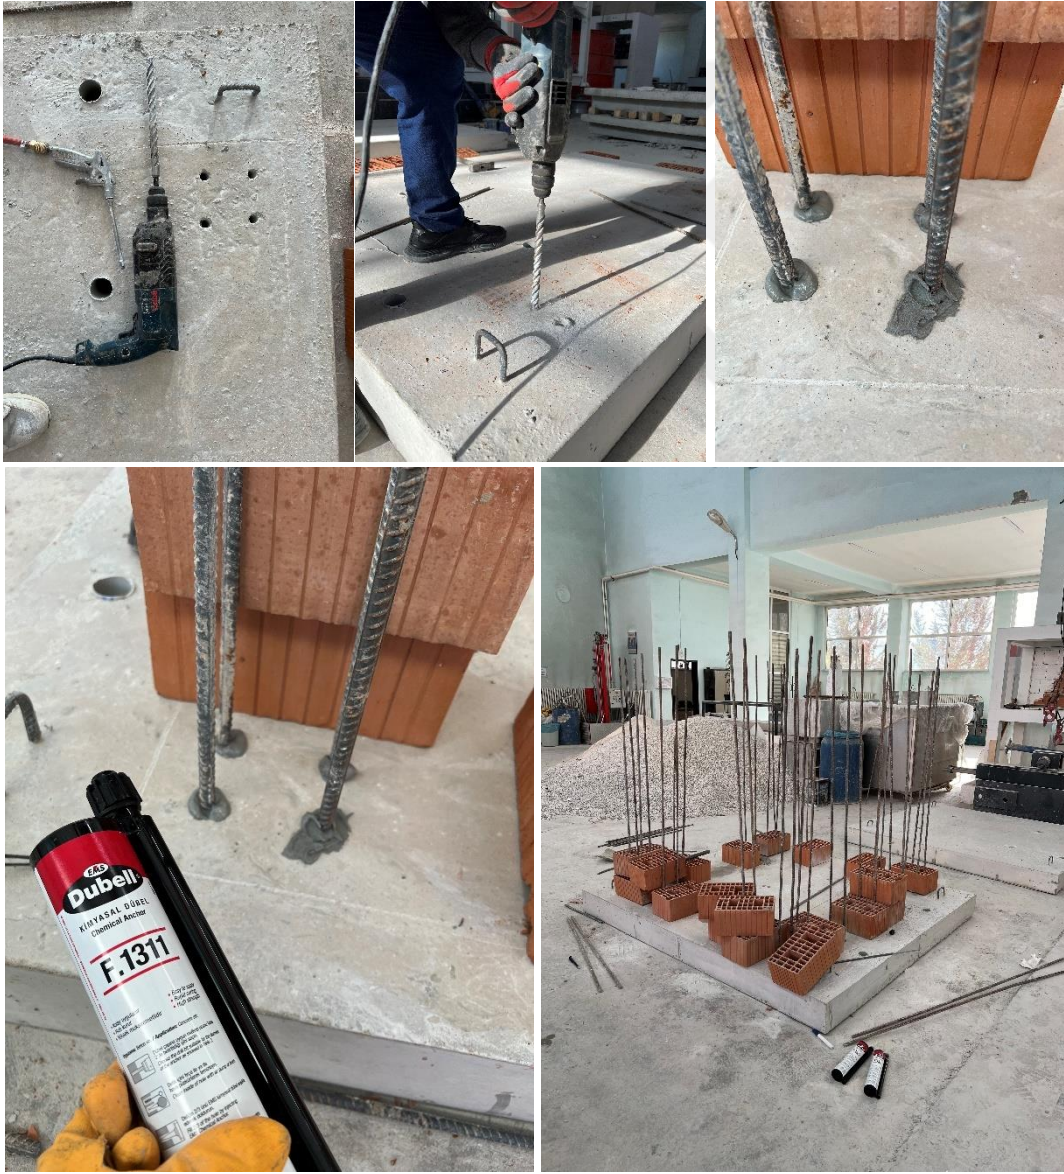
Temellerin beton dökümü sonrasındaki hali
